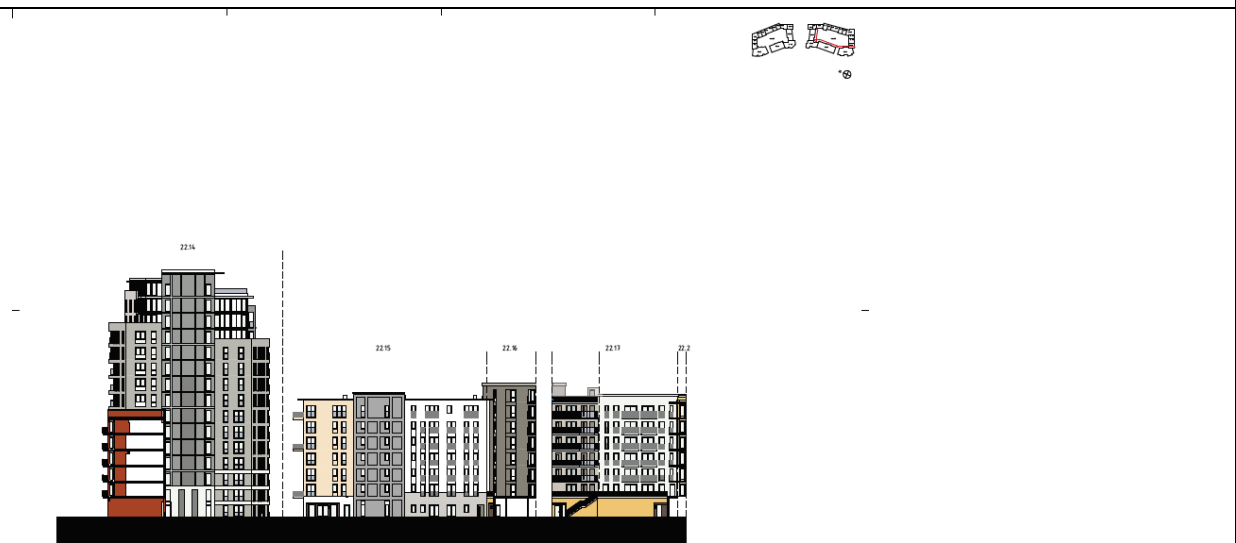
E: Zuidgevel Blok 23 (en Toren 23) – tekening nr. 123a, d.d. 23-3-2017
